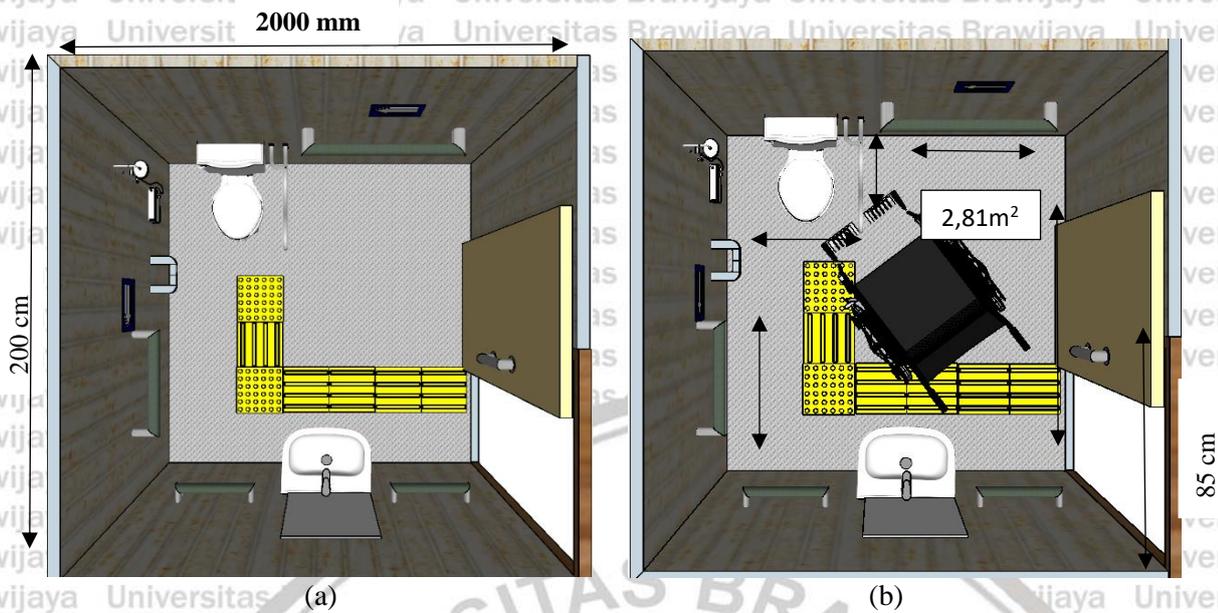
Fasilitas pada desain (*layout 2*)
